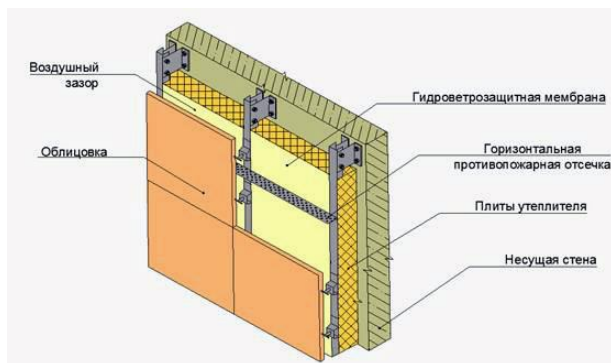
Отделочное решение наружных стен с применением вентилируемого фасада
